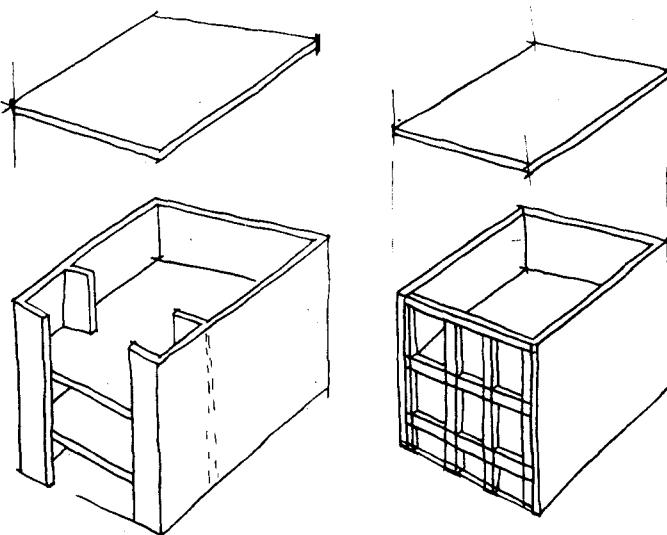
Решение 3. Жесткие рамные или связевые каркасы встроены в стену фасада
